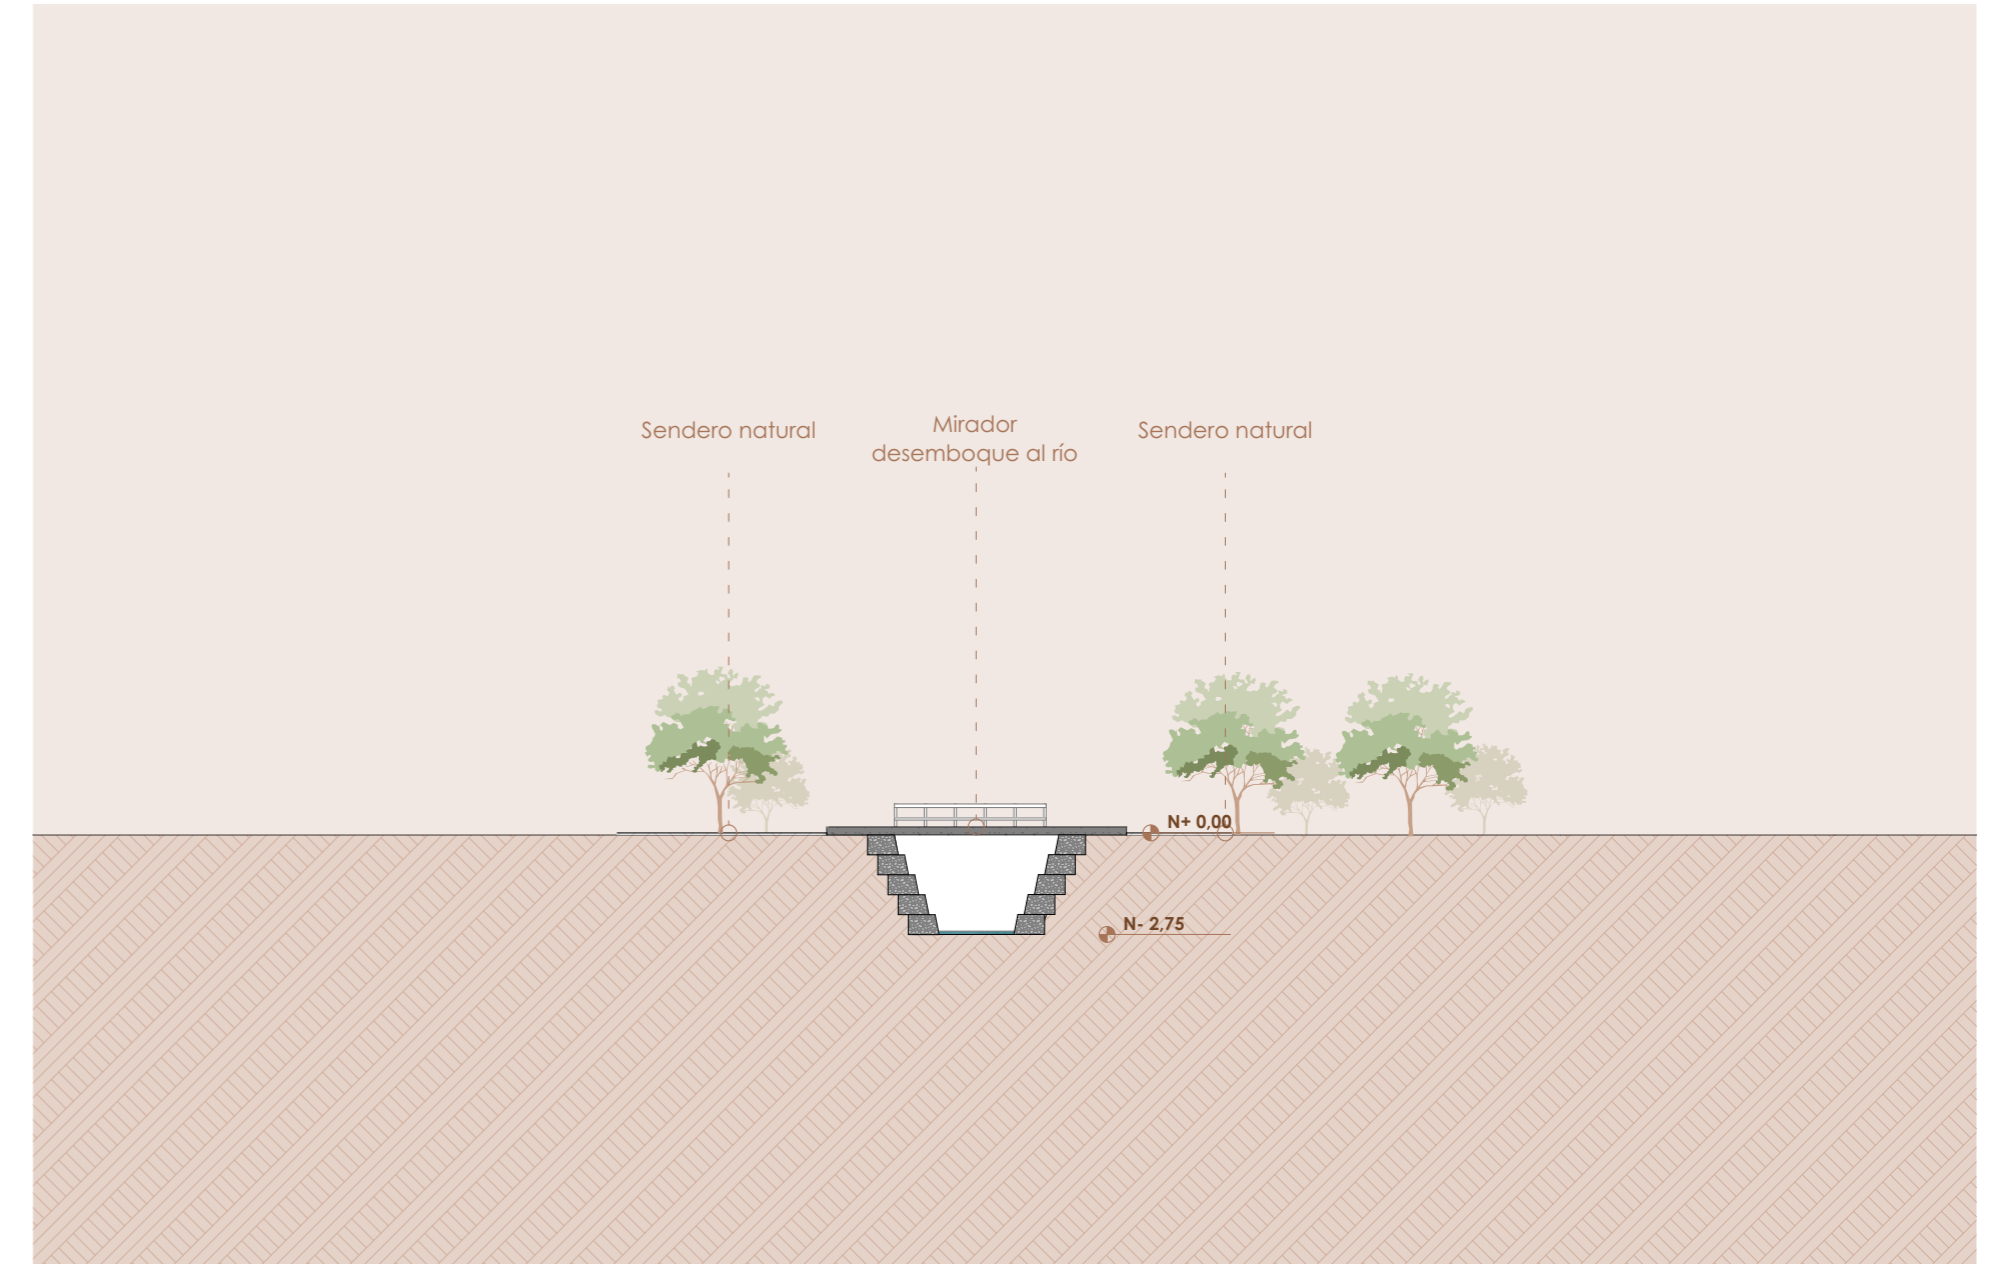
Sección 08 - Tramo 3. Fuente: Autoría propia (2026).
